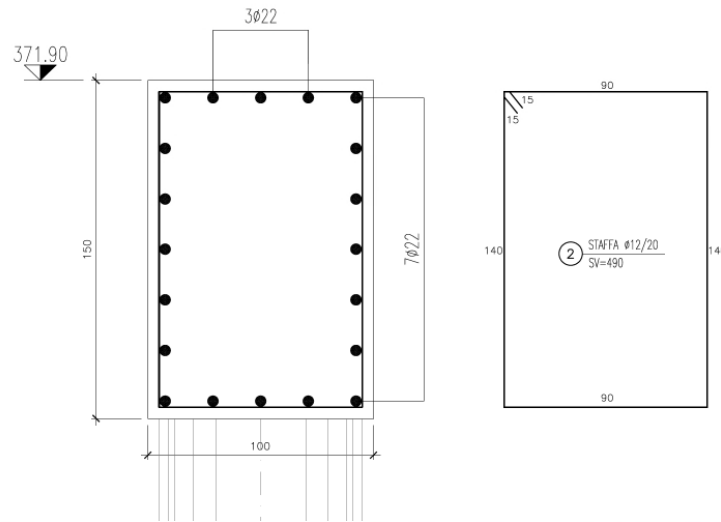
Verifica strutturale SLU - Sezione 3
